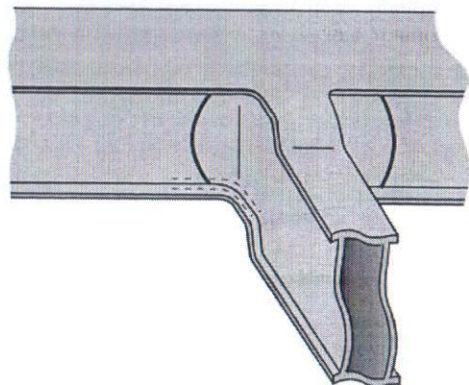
Контроль околошовной зоны сварного соединения нижнего пояса с боковыми стенками в переходе от продольной балки к поперечной
